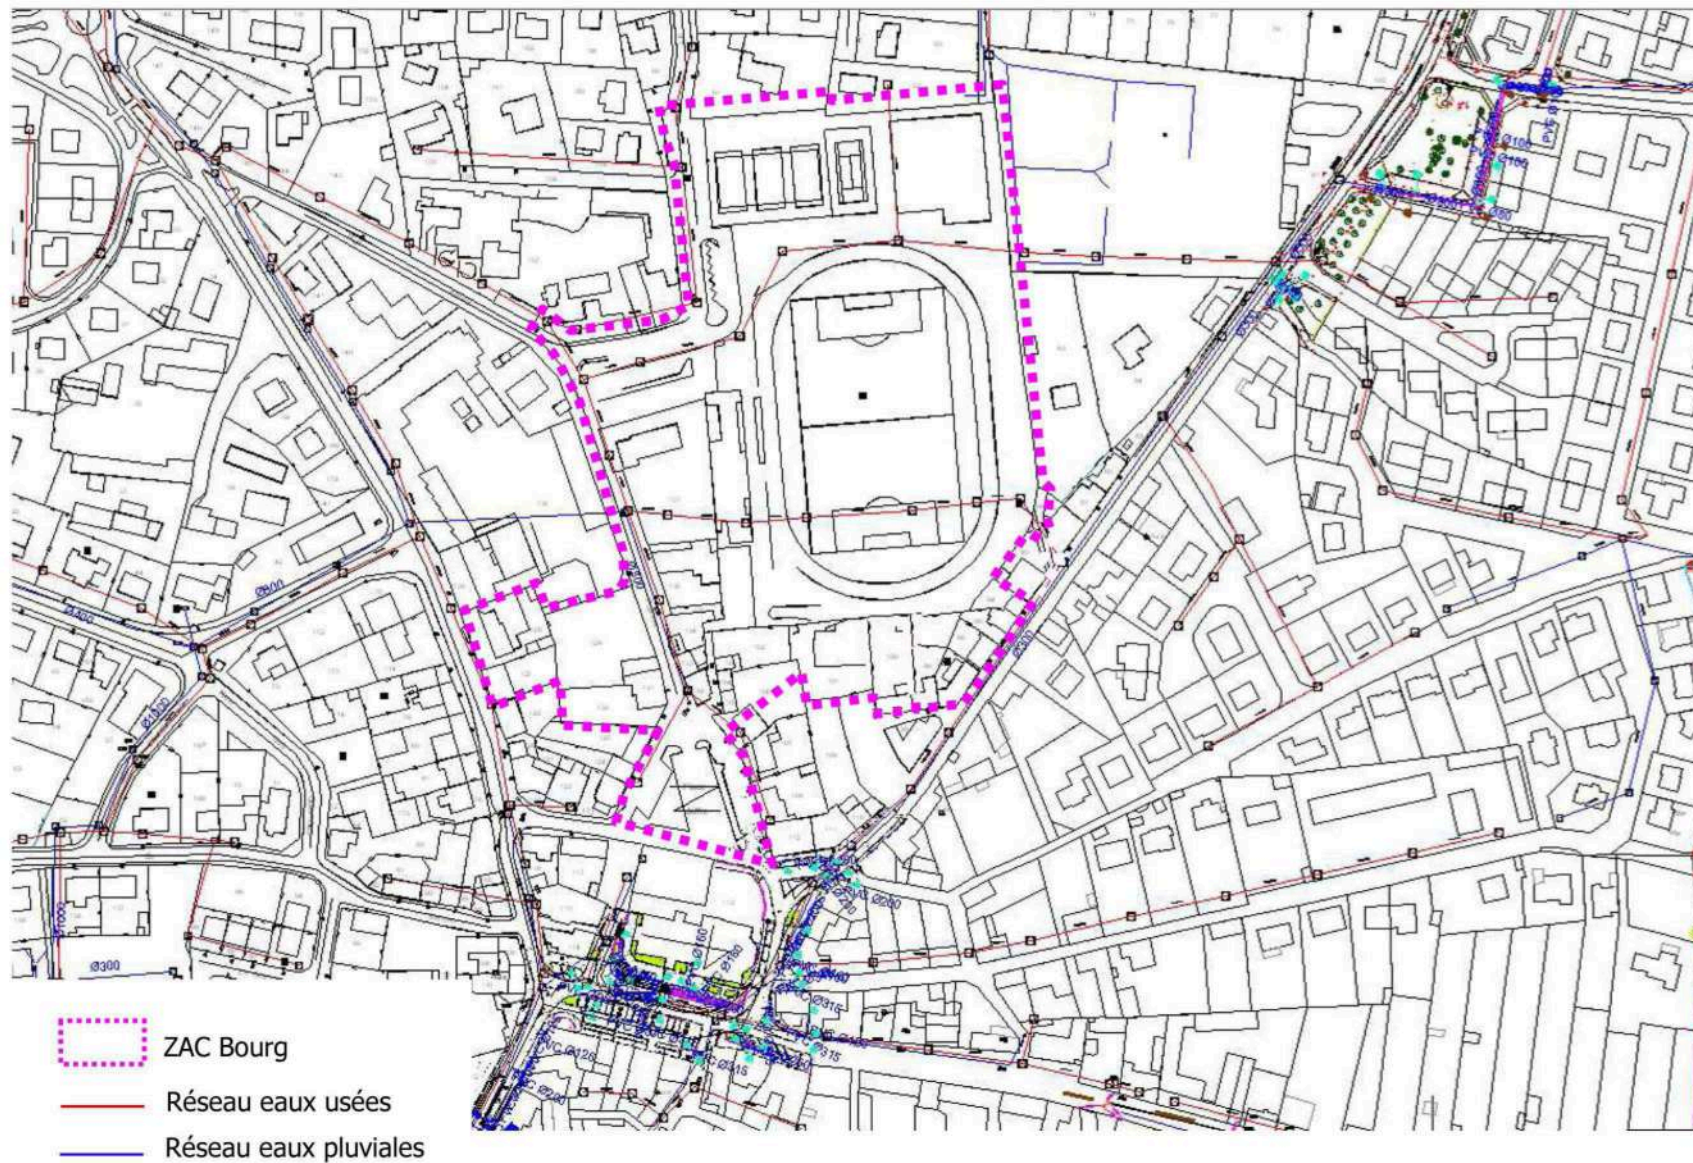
Réseau eaux usées et eaux pluviales au droit de la ZAC de la Saudraye
